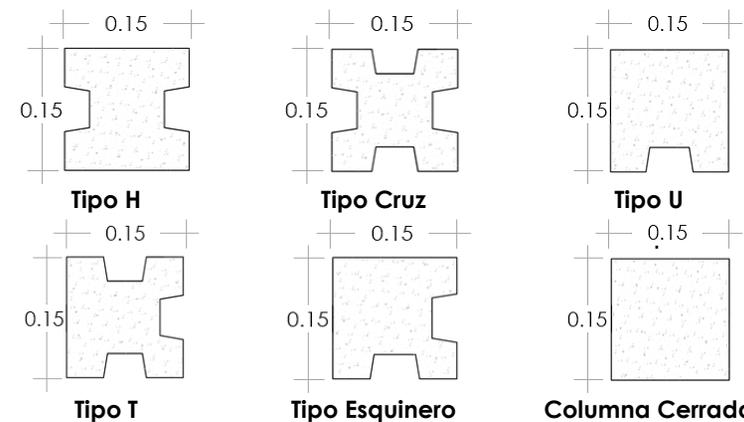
Secciones transversales típicas de columnas prefabricadas de bloque panel. Fuente: Manual Técnico Sistema Constructivo Bloque Panel.
